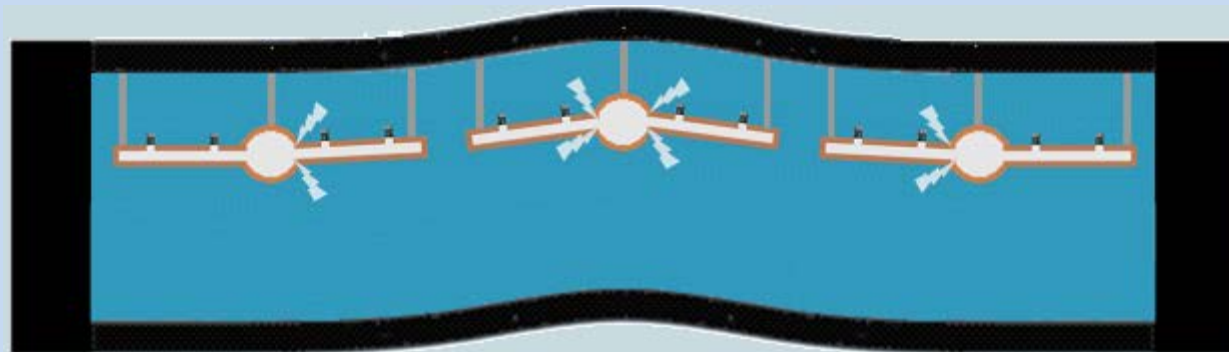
Разрушение герметичности стыков трубопроводов при резонансных колебаниях. Положение жёстко подвешенных распределительных  и питающих  трубопроводов при отклонении упругой конструкции из плит подвала вверх от положения устойчивого равновесия. -спринклер. -подвеска. -утечка воздуха.
